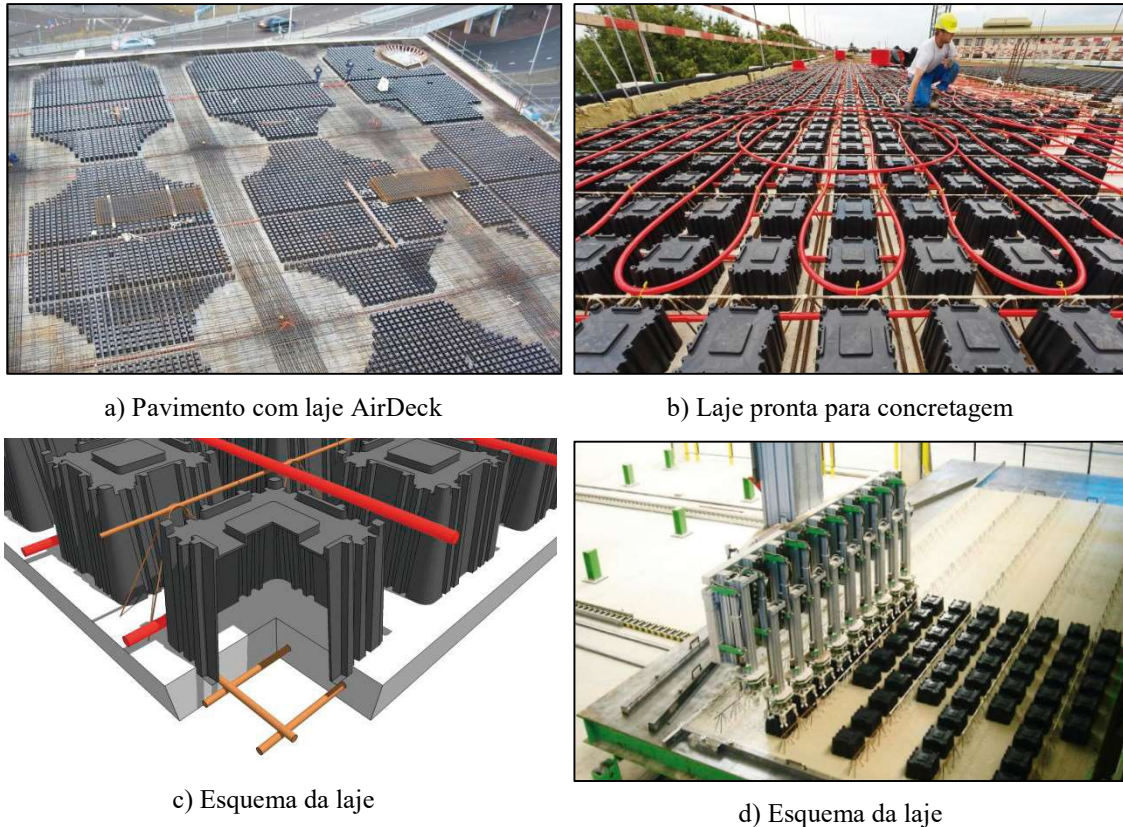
Lajes AirDeck (Página Web AirDeck⁹)
